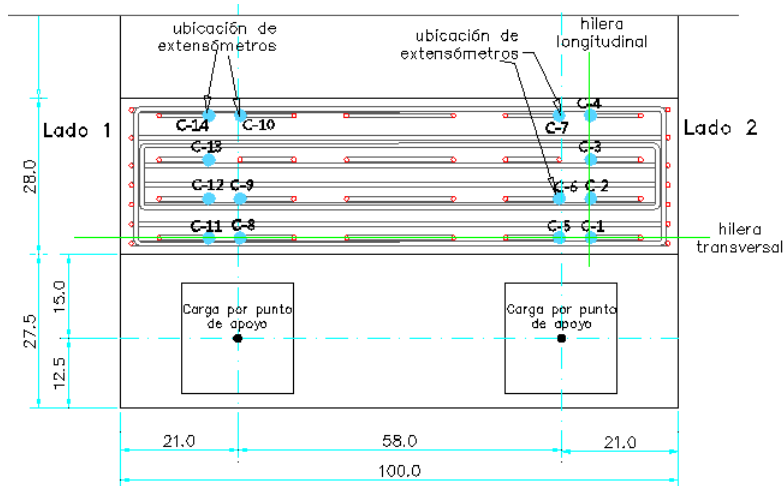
Ubicación de colgantes y extensómetros (vista en planta): especímenes E1 y E2
